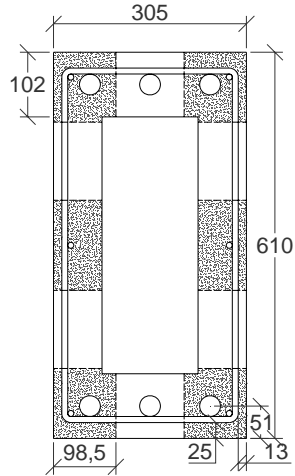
Sección transversal de la viga del ensayo de Abersman y Conte (1973). Detalle de las áreas efectivas de la armadura pasiva longitudinal, según el criterio definido en el MC CEB-FIP 1990.
